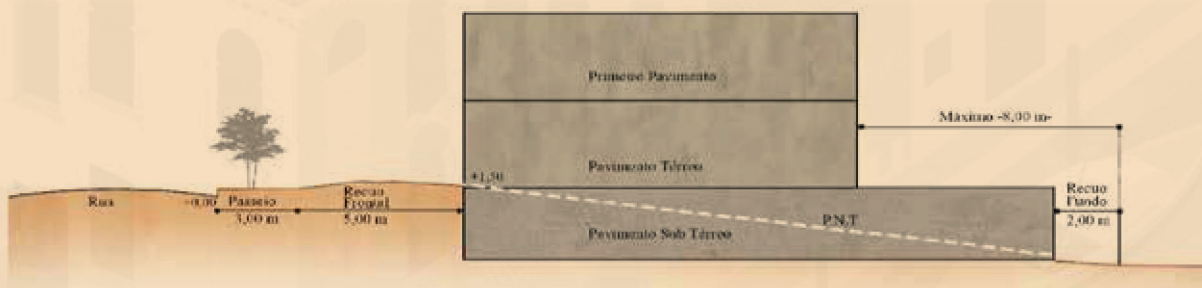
Construção com 3 Pavimentos para Lotes com Declive
